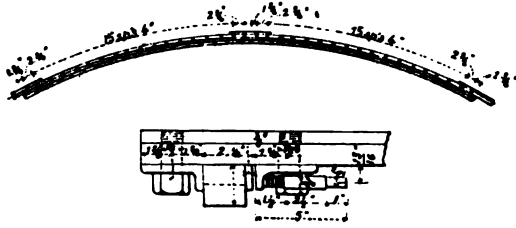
Détails de l'enveloppe du bouclier et de la rondelle en caoutchouc.
